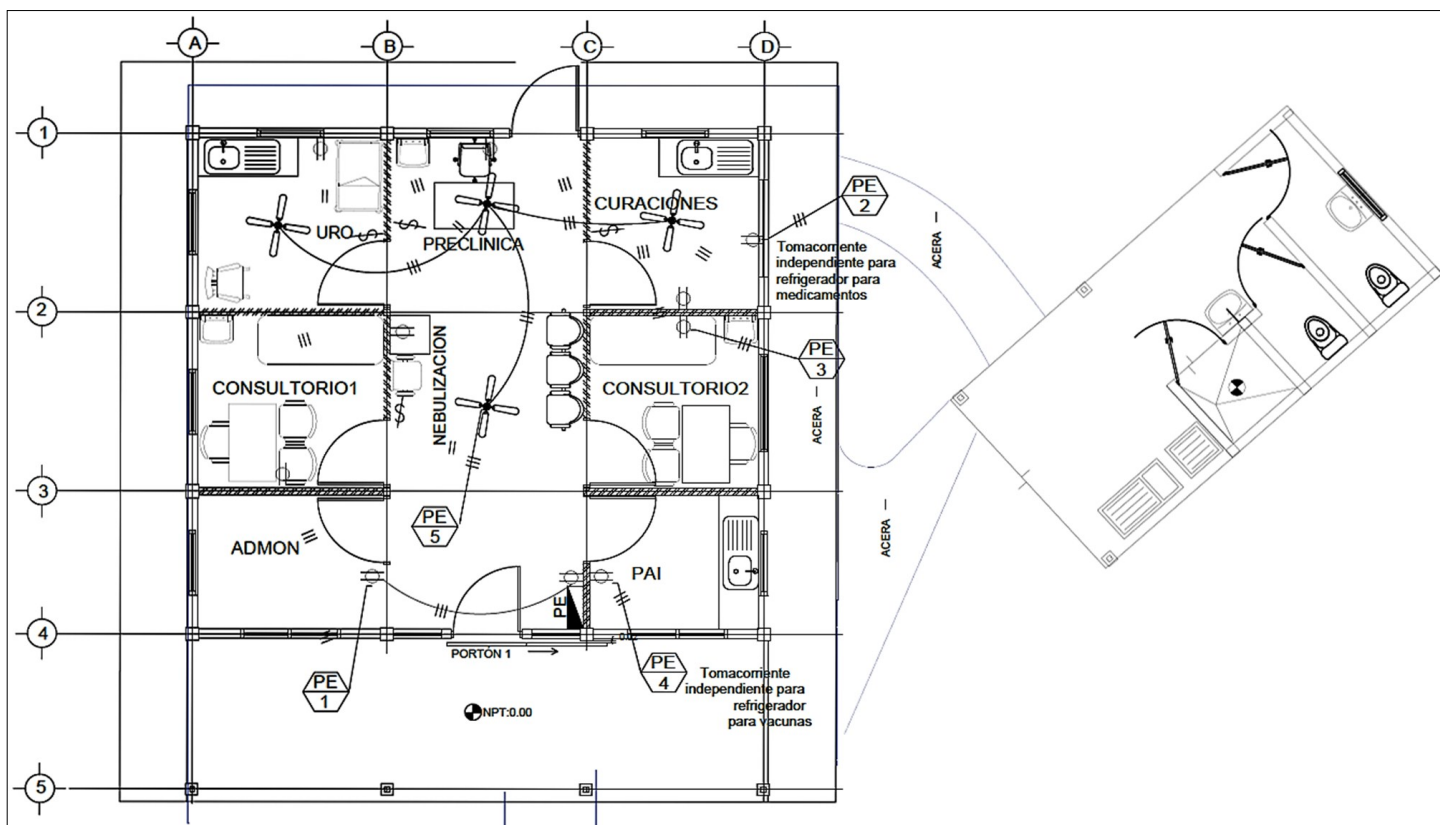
Planta de luminarias niños Mártires/Fuente: Elaboración propia.
